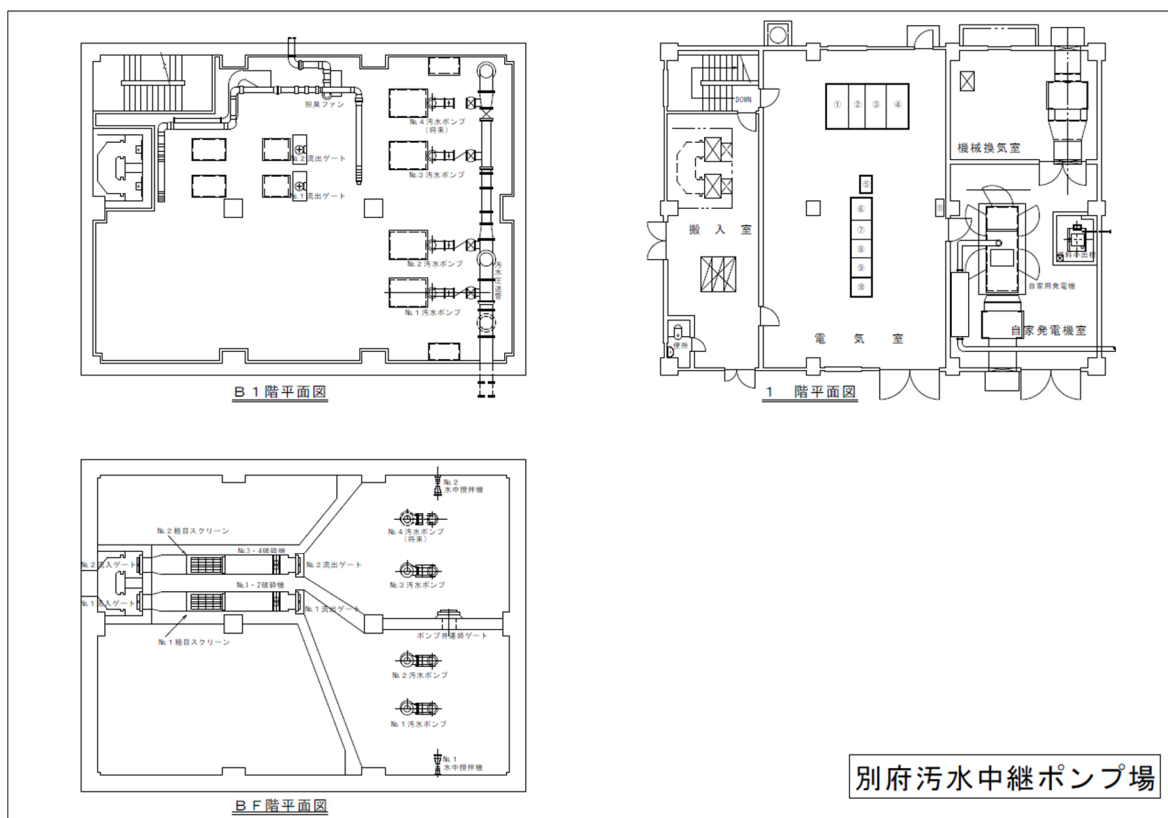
別府汚水中継ポンプ場の計画一般平面図
